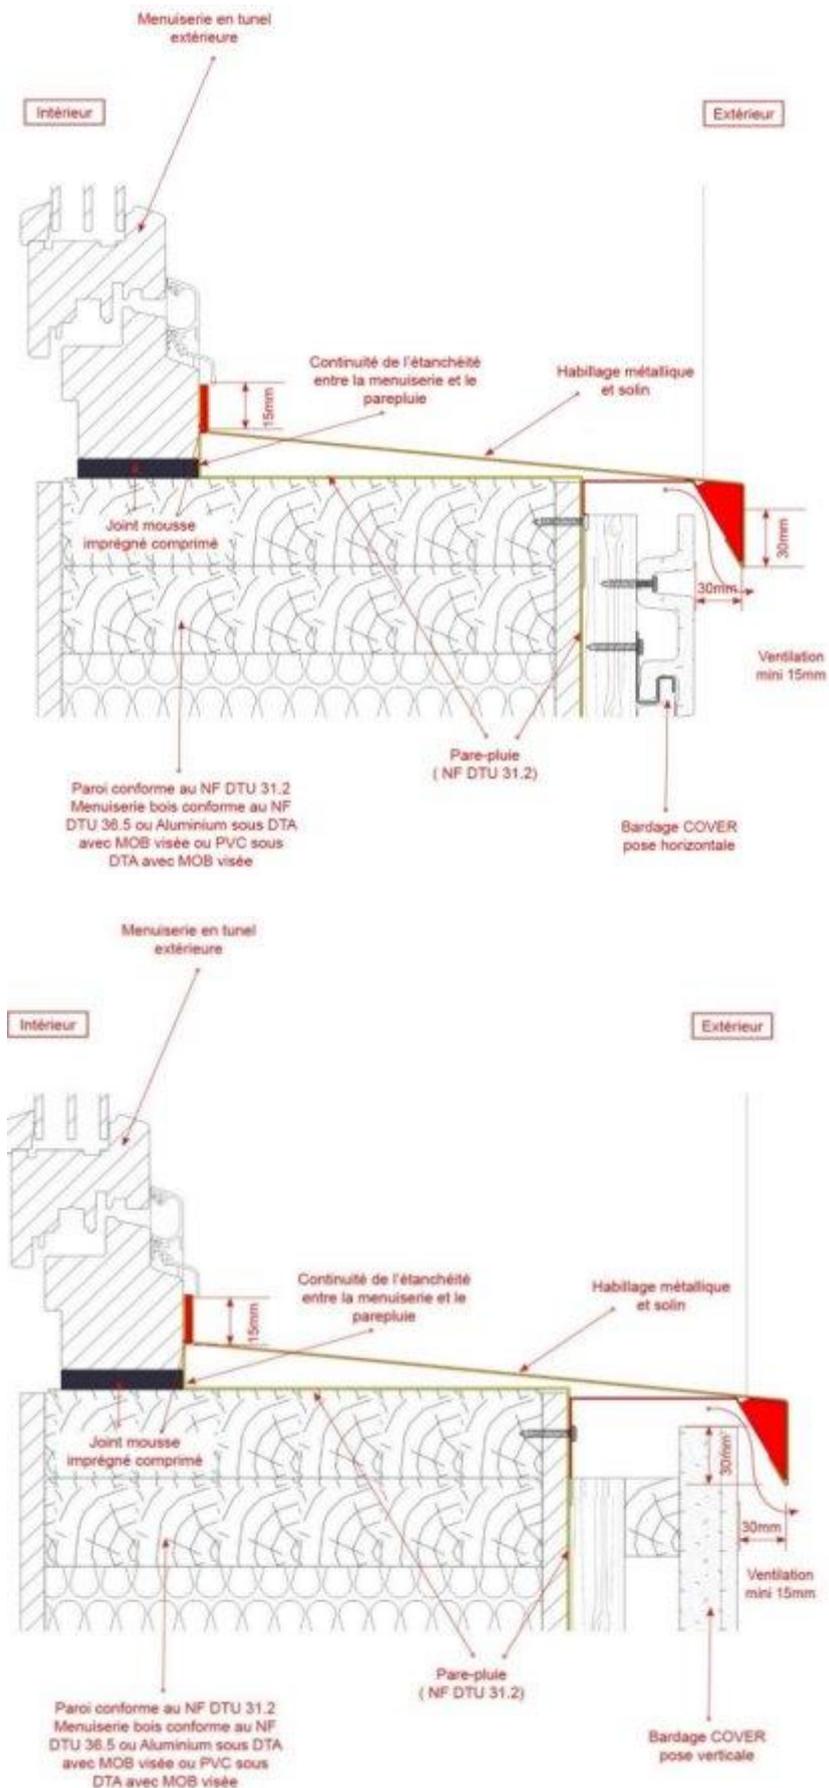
Appui de baie sur COB avec bardage en pose horizontale ou verticale Dispositions particulières des traitements des baies (Menuiserie en tunnel au nu intérieur)
